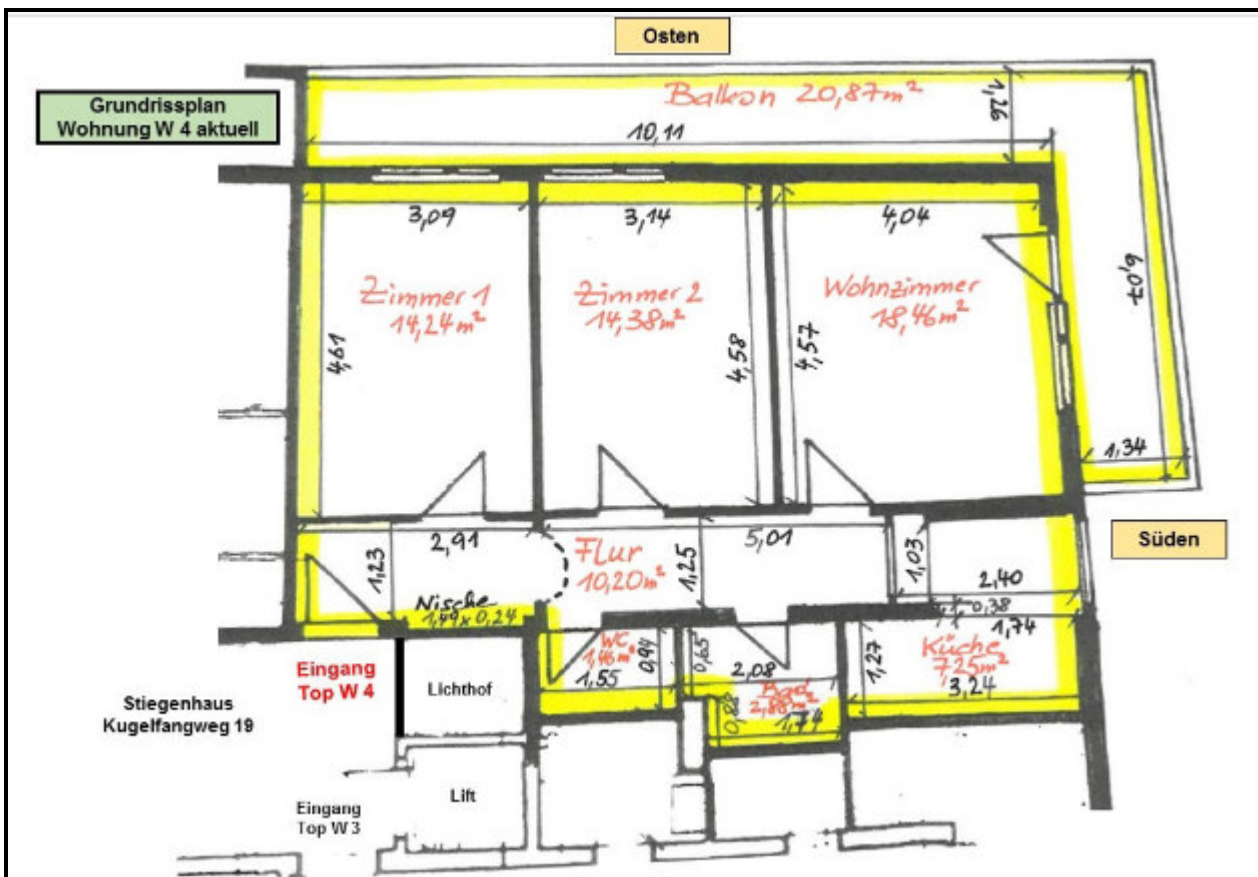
Grundrissplan Wohnung Top W 4
